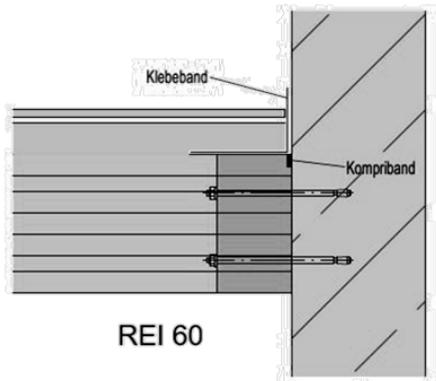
Anschluss BSP-Decke an Betonwand [B. Walter Ingenieurgesell. mbH]
